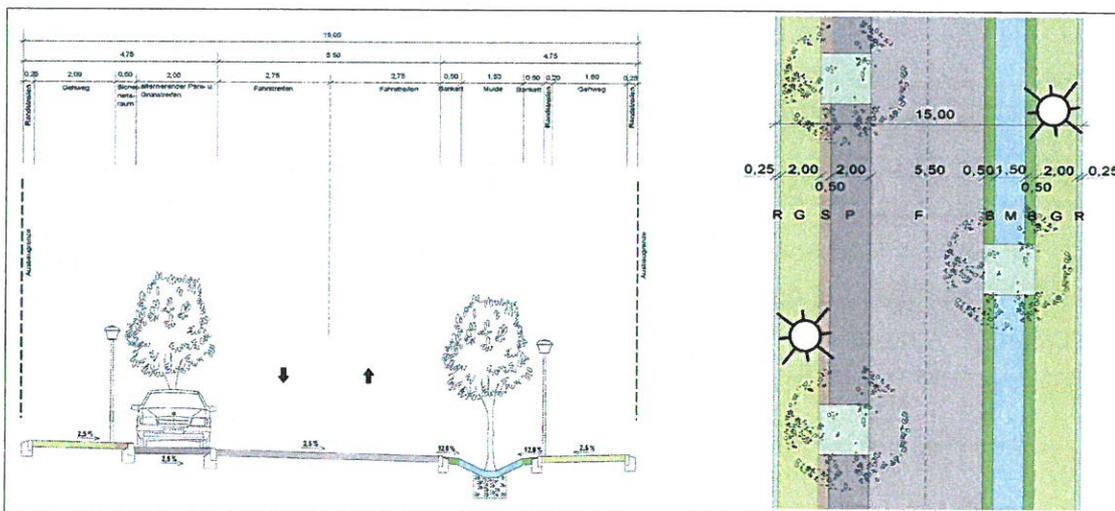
Prinzipquerschnitt der Planstraße B - PST
